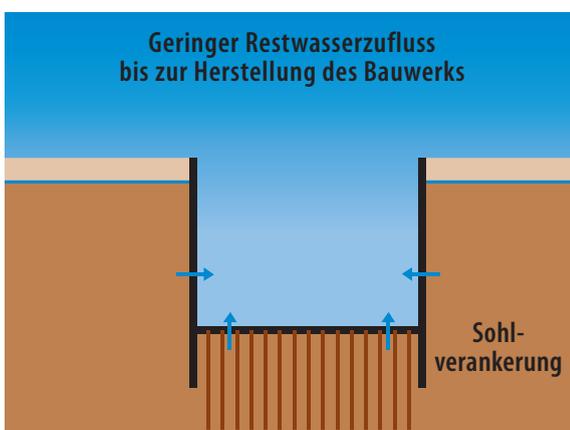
bis 3.3-8 Herstellung einer Trogbaugrube mit Unterwasserbetonsohle am Potsdamer Platz
